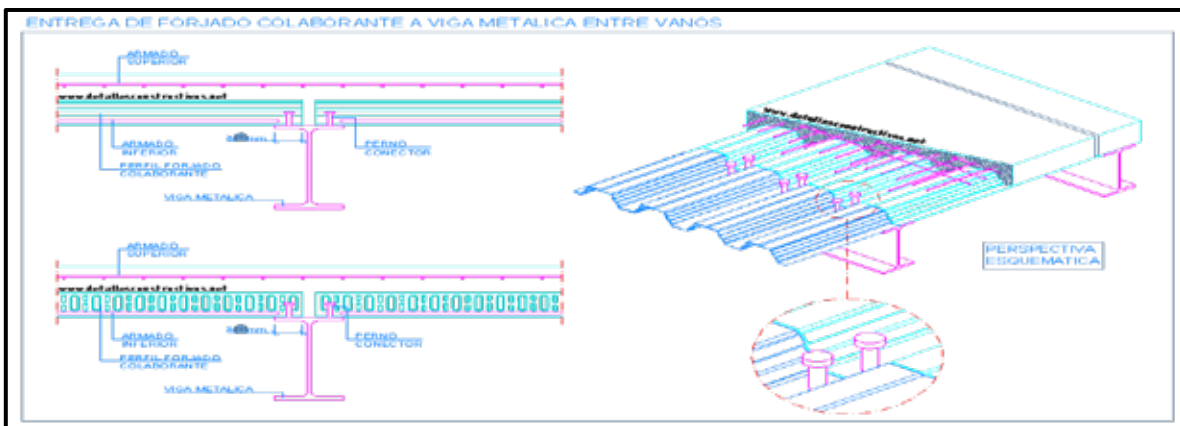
Detalle de losacero. <http://www.detallesconstructivos.net/categoria/claves/losacero>.(2017).
